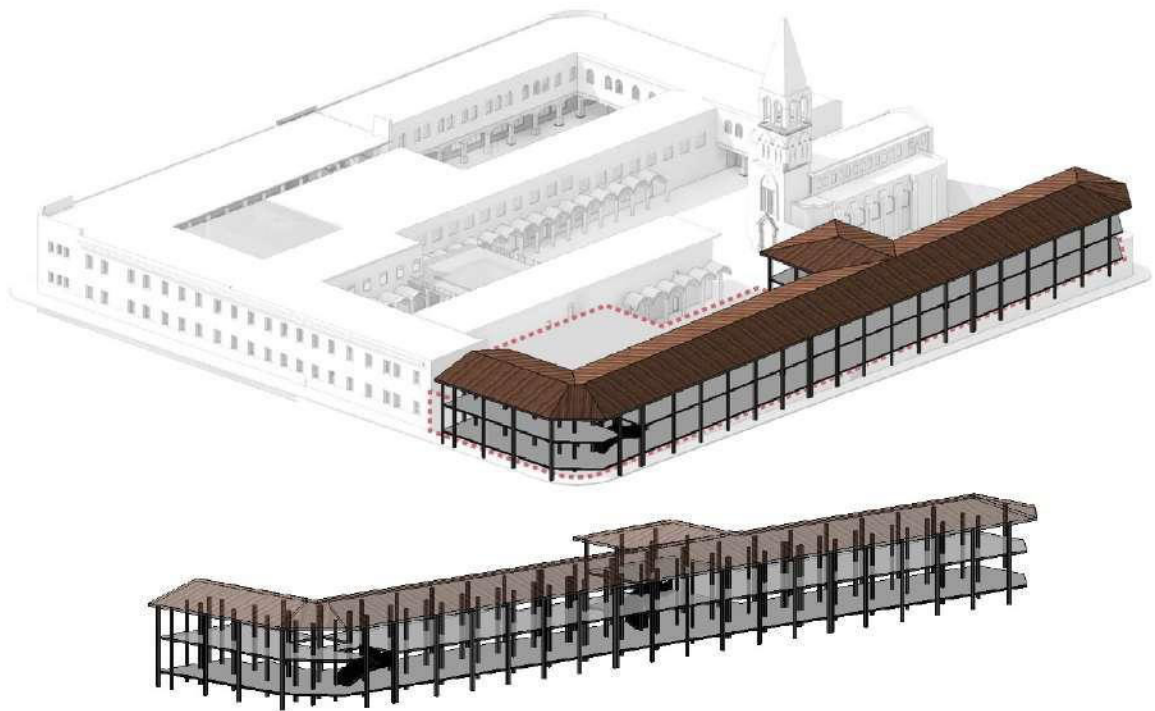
Estructura. Fuente: Elaboración propia
